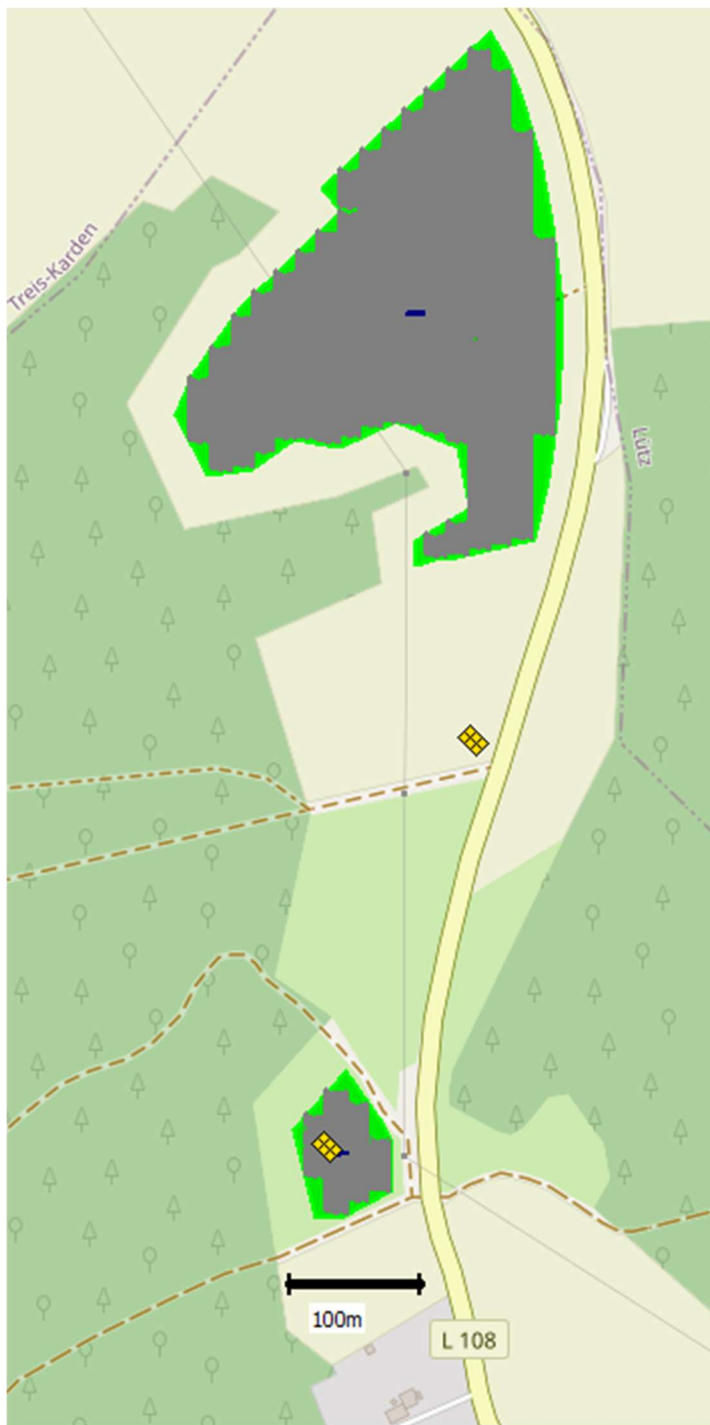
Lageplan – Gesamt mit PV-Modul Belegung in grau.
